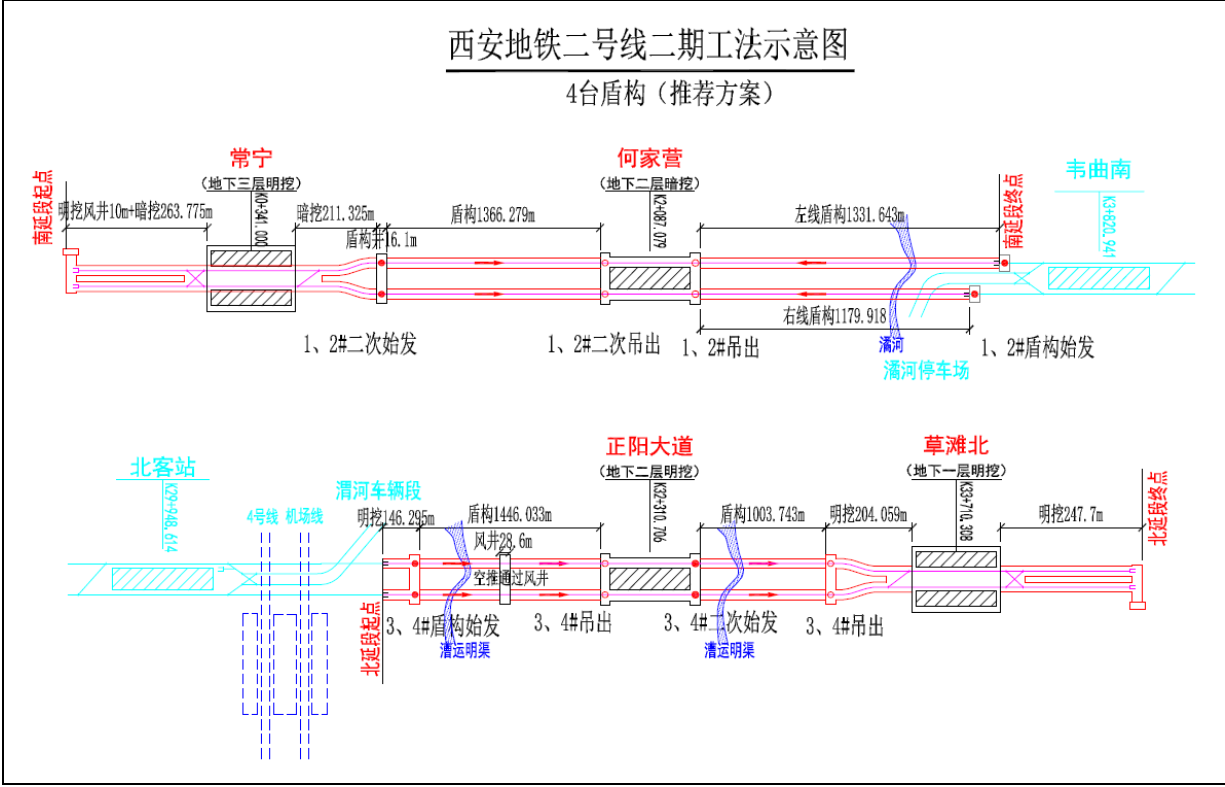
地铁二号线二期工程各段区间隧道施工方法示意图
